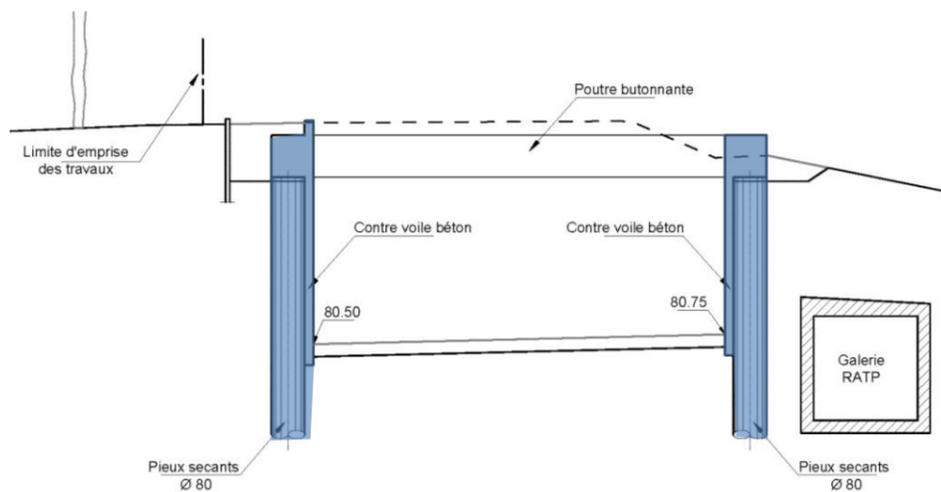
Coupe transversale des murs de tête du tunnel RATP (Source : AVP- juillet 2015)
